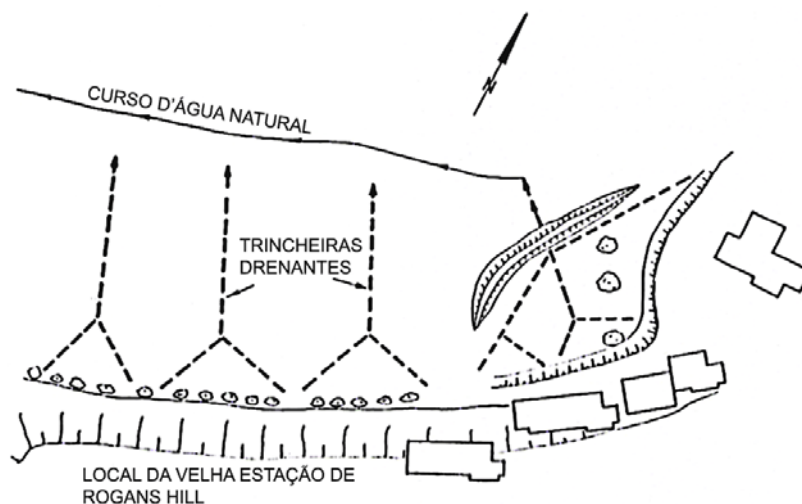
Configuração das trincheiras em planta (Jeffery, 1987).
